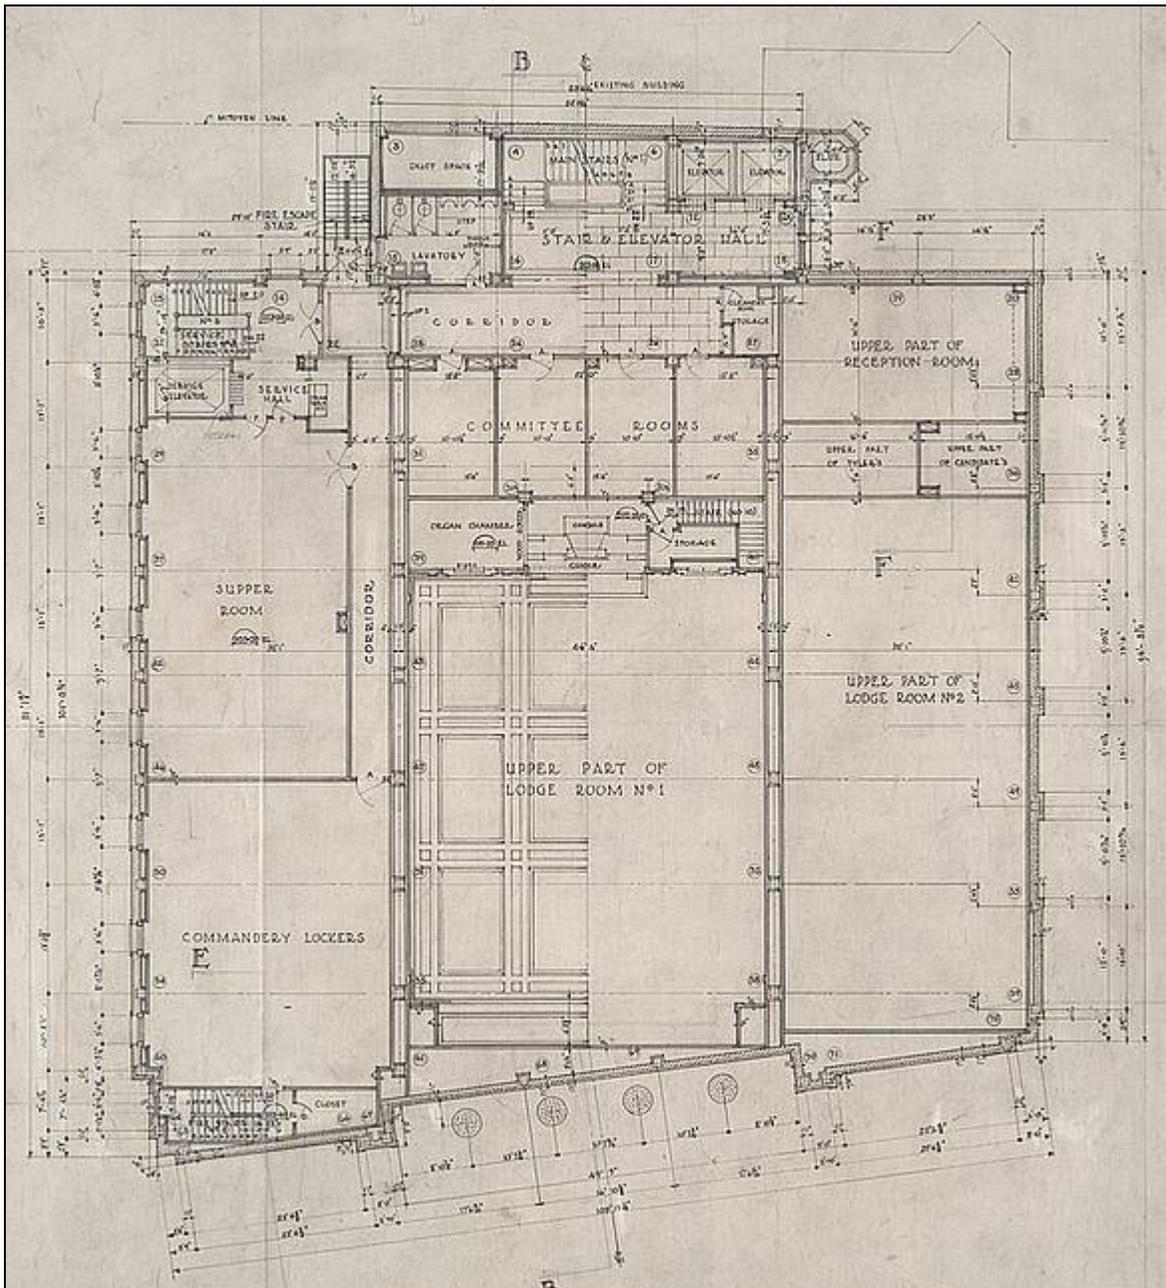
Plan du *first floor mezzanine*, ou étage n° 6 (détail de la feuille du plan). Plans de John S. Archibald, Université McGill, collection CAC.
